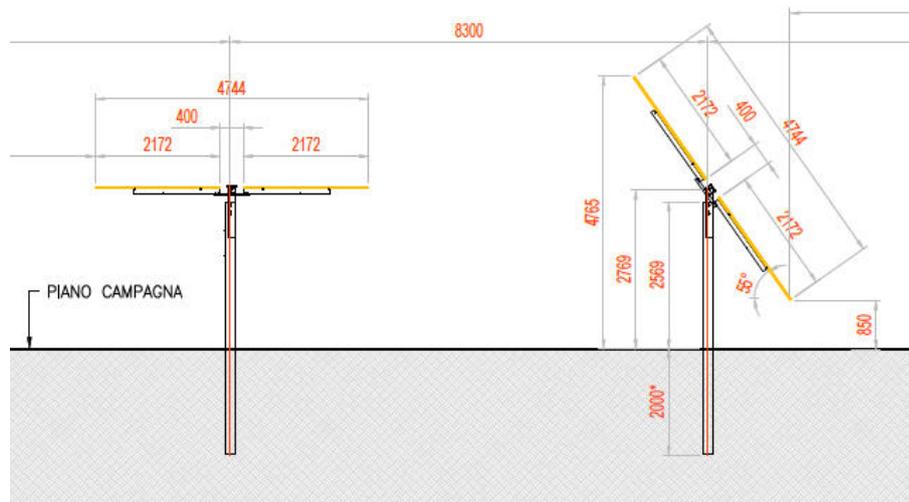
Particolare strutture di sostegno moduli, sezione trasversale.
